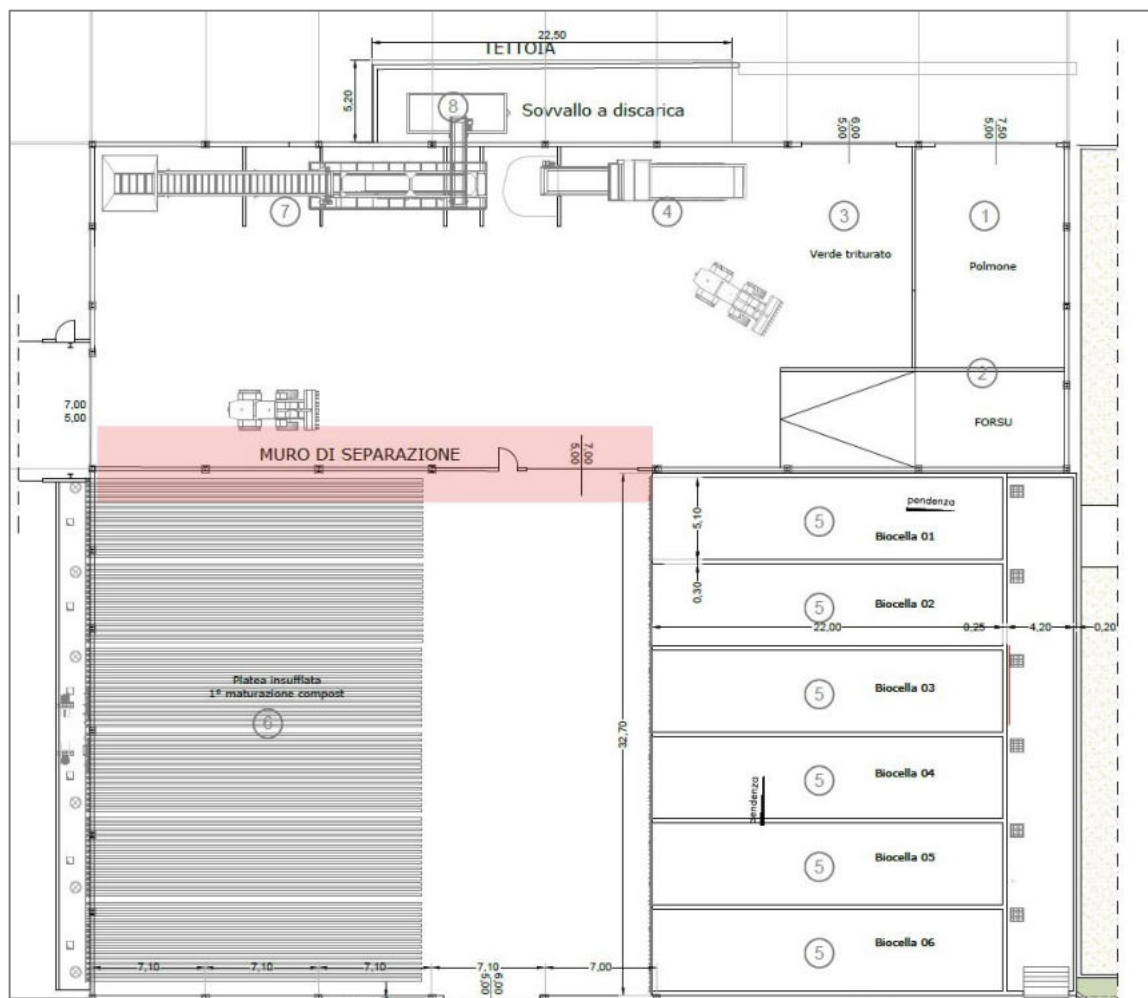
PIANTA DI DETTAGLIO – COLLOCAZIONE del MURO DI SEPARAZIONE
